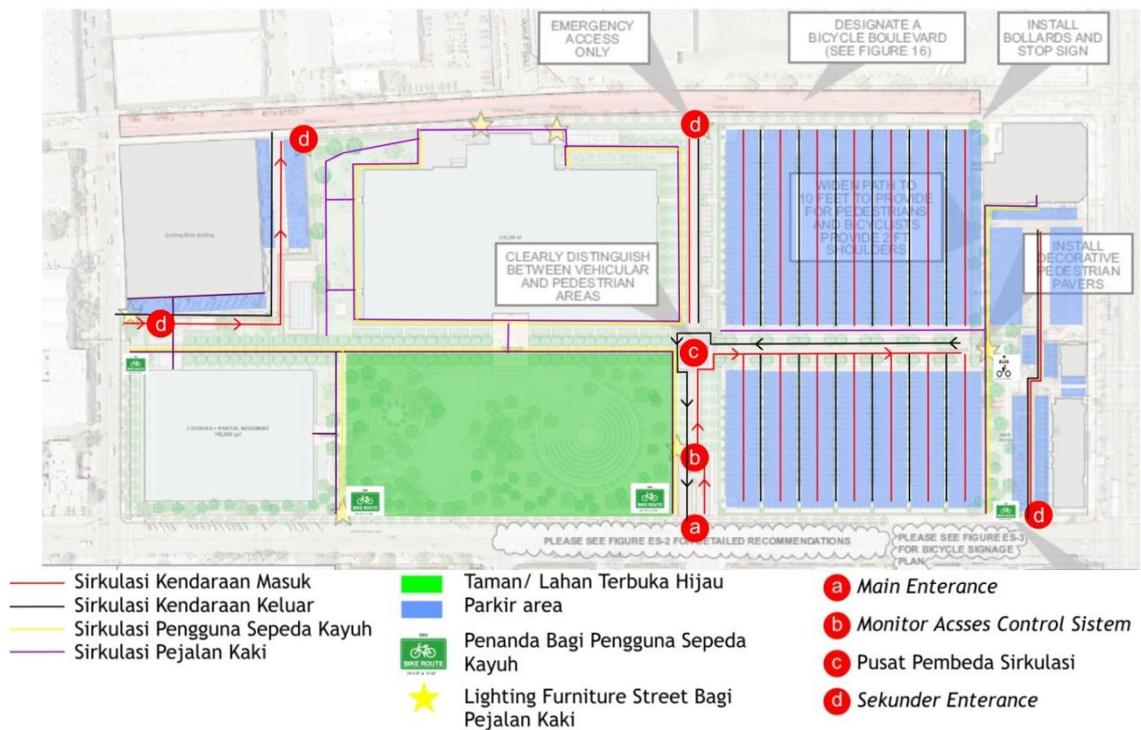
Gambar Analisa Site Plan Studi Banding
